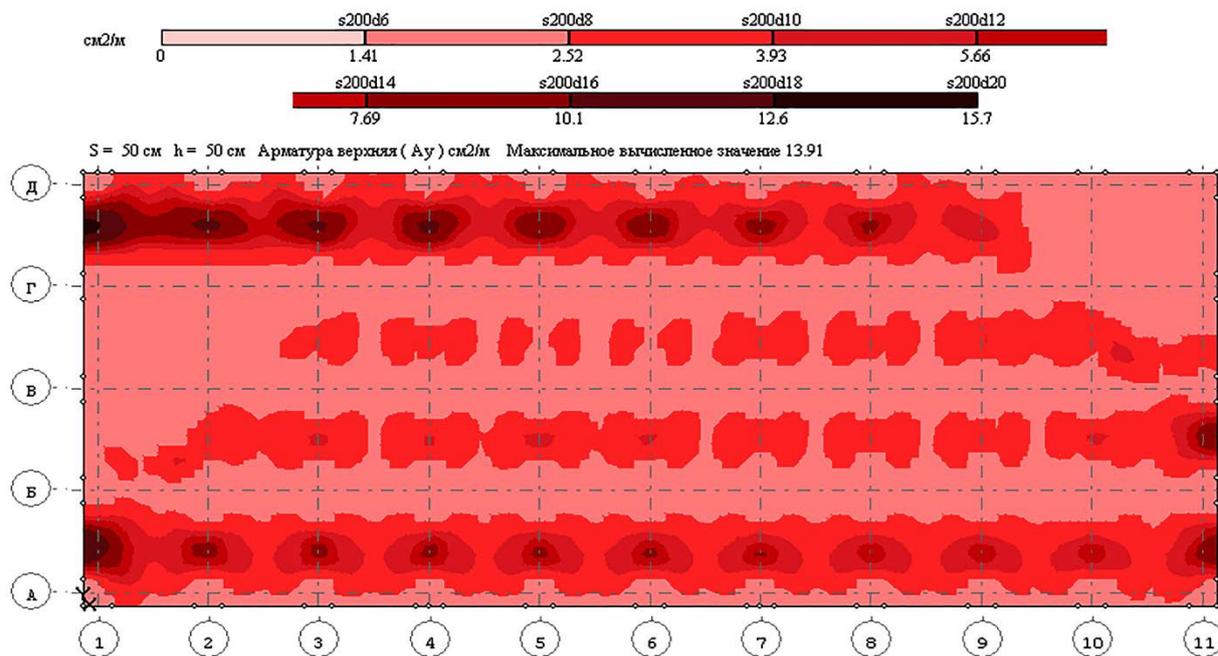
Мозаика расчетного армирования фундаментной плиты по верху в направлении оси Y
